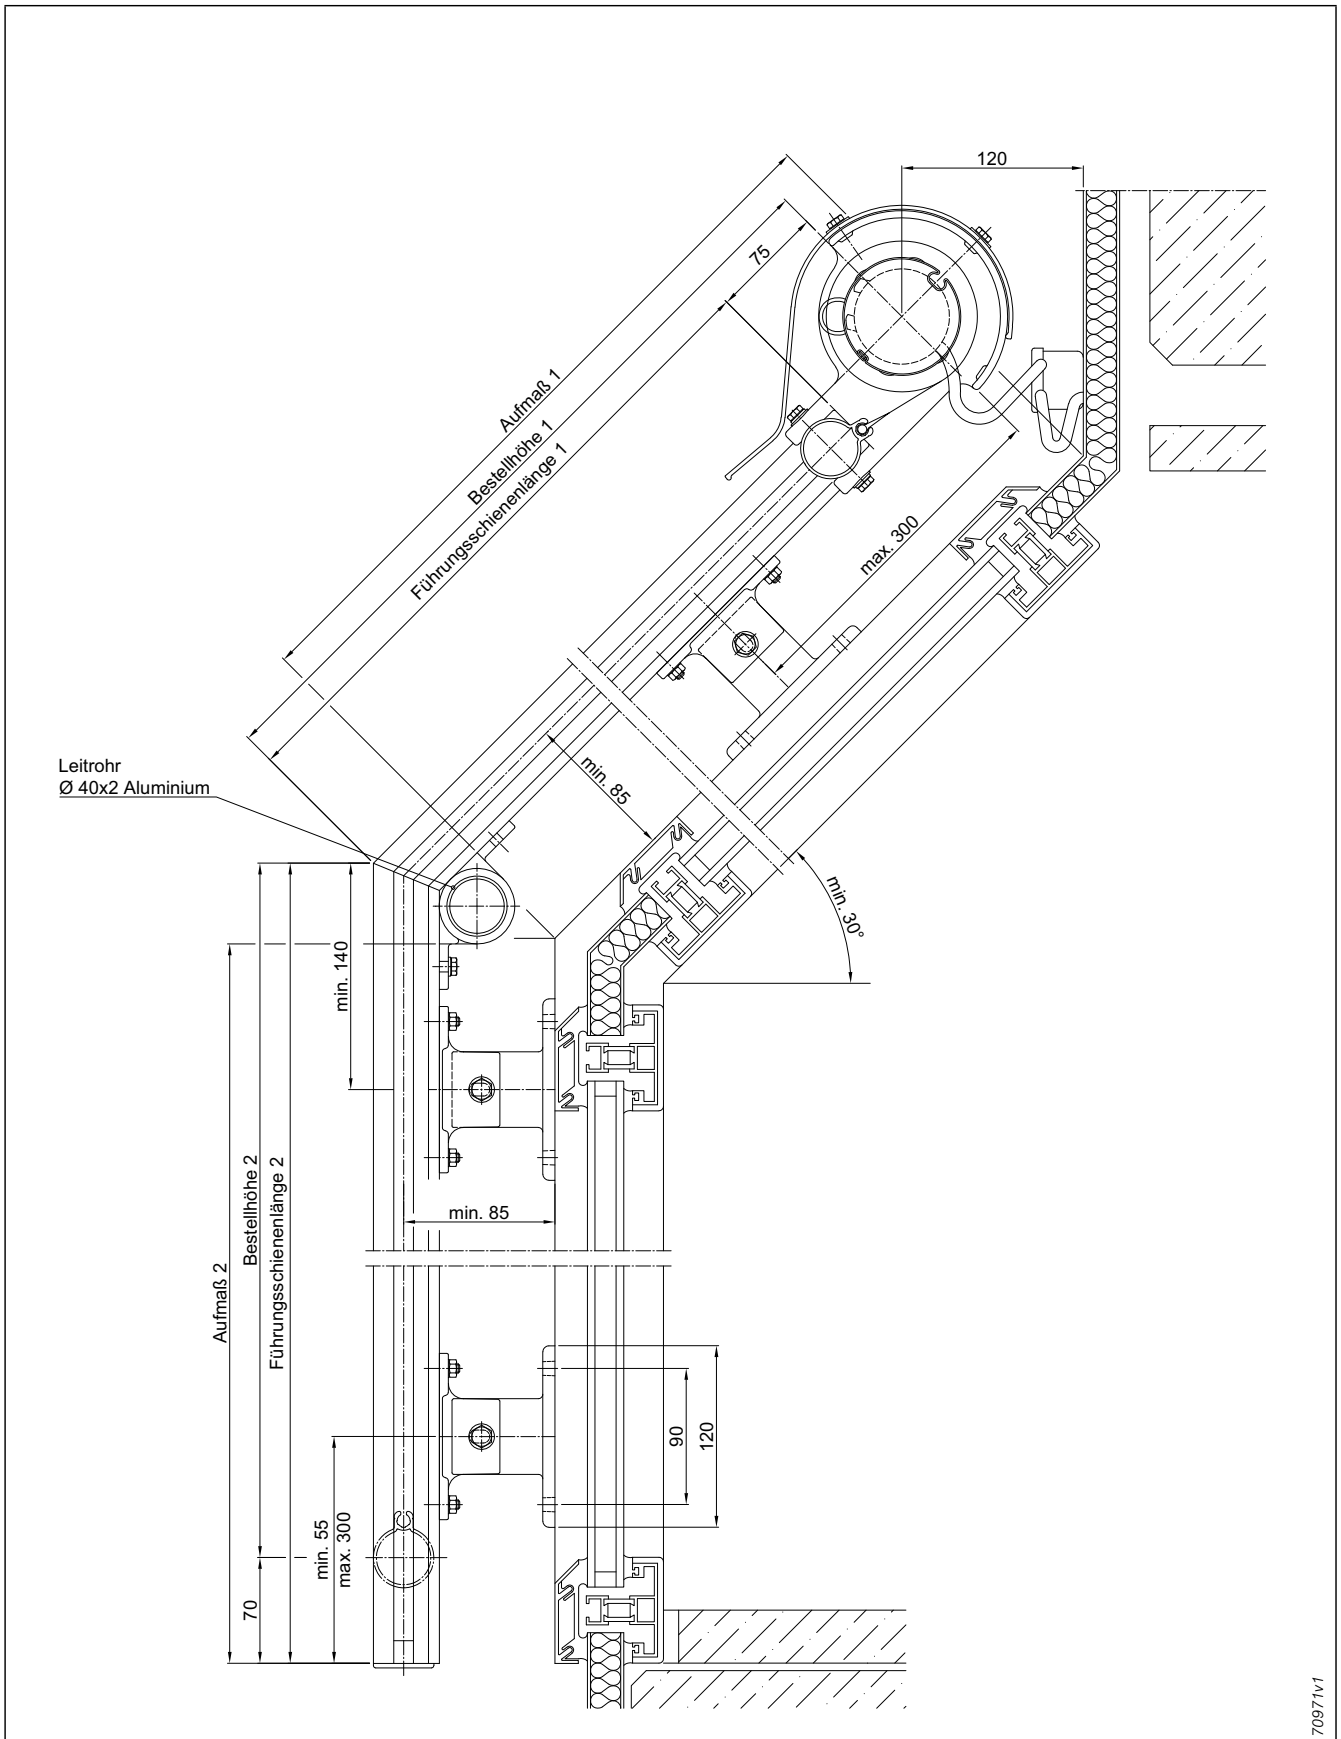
Fassaden-Markise 203 mit Halbrundblende Typ 2.3 um 40° gedreht
